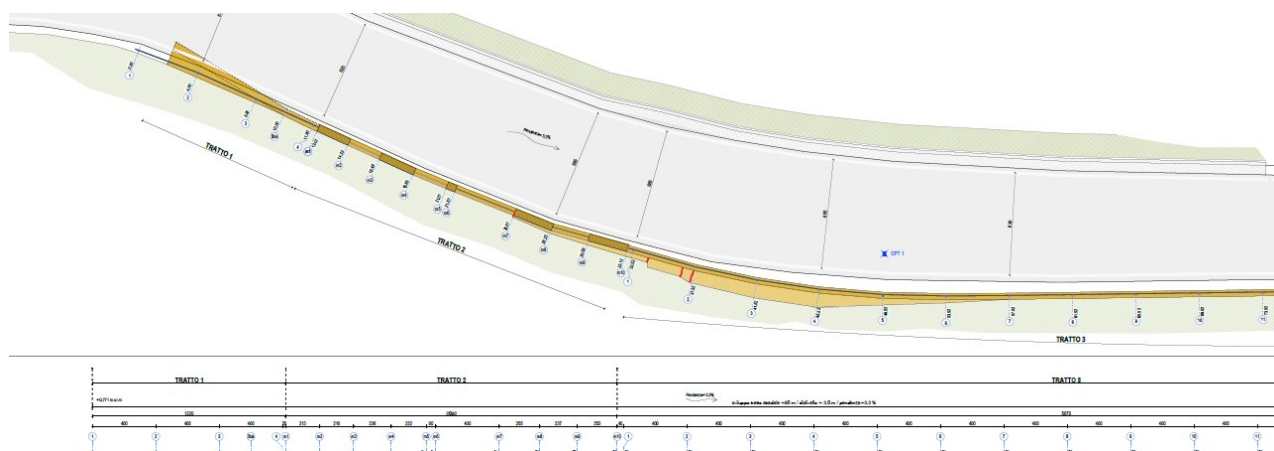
Planimetria e prospettiva dello stato di fatto.
